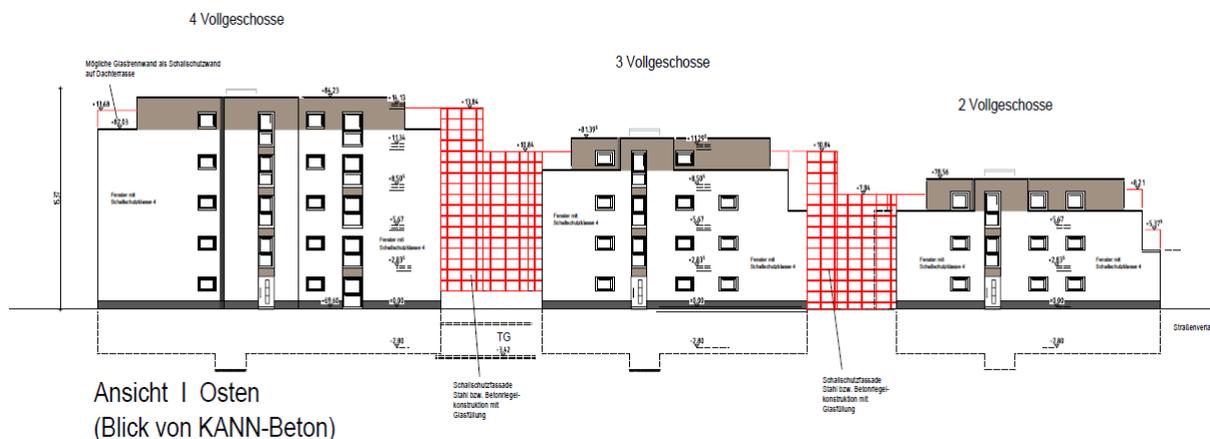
Ansicht Ostfassade des städtebaulichen Konzepts (Stand: Februar 2016) (rot markiert: eingestellte Glasfassaden zur Schallisolierung rückwärtiger Bereiche)
